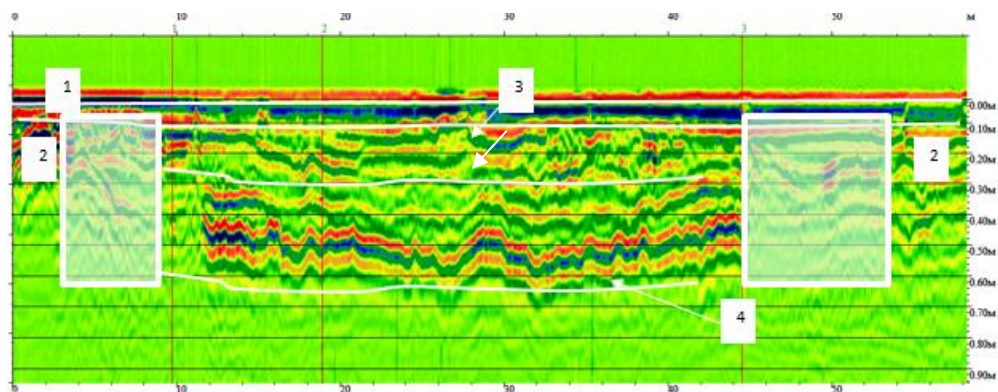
Радарограмма вдоль моста. 1 – асфальтобетон толщиной 100 – 120 мм (имеются наплывы); 2 – фундаменты опор балок моста до глубины 1,5 м; 3 – бетонные плиты толщиной 300 мм; 4 – выравнивающий слой бетона толщиной 350 мм
